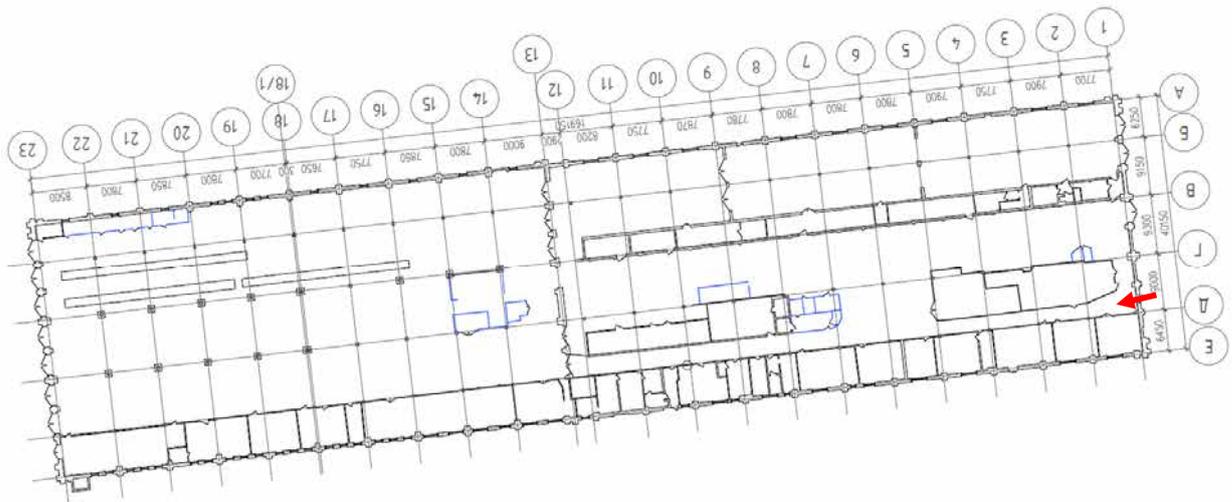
Здания депо под литерой С – помещения исторической одноэтажной пристройки со стороны южного фасада.
